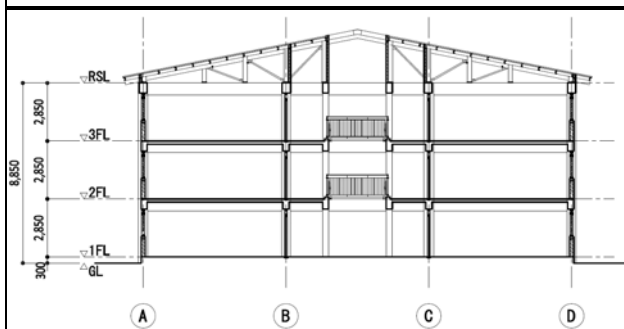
Construction 3 étages 2 salles de classe avec passage latéral (Type C)
